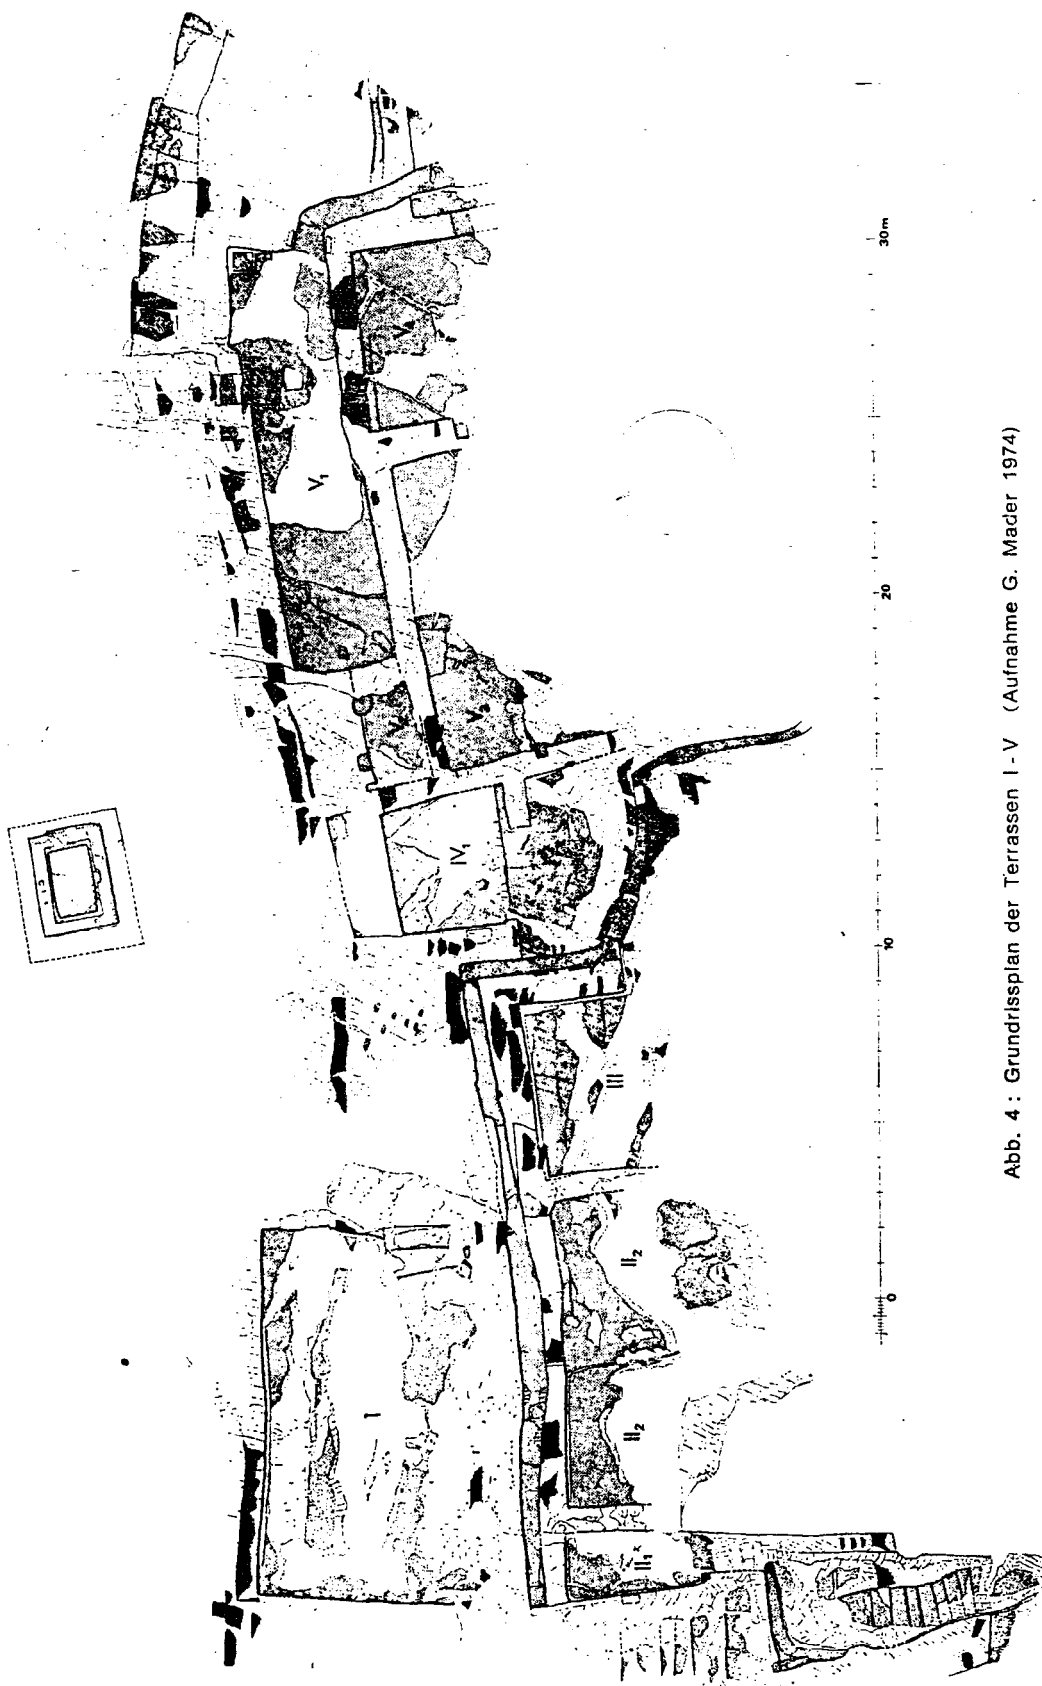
Grundrissplan der Terrassen I - V (Aufnahme G. Mader 1974)
